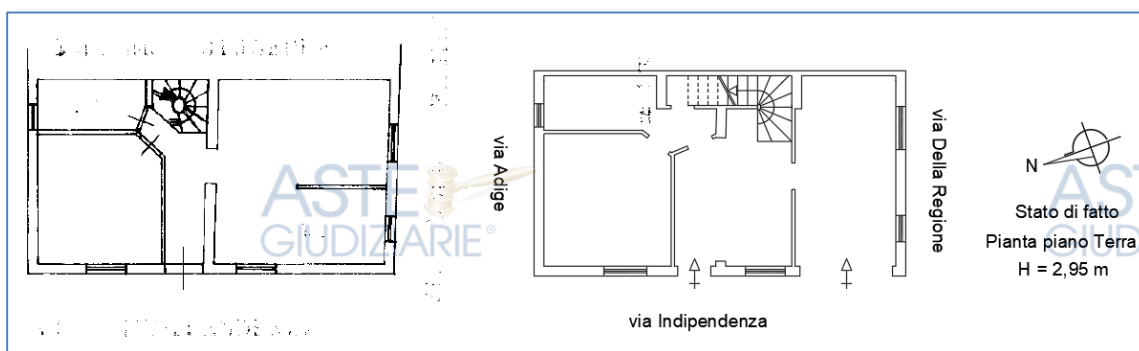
Confronto tra la Planimetria catastale a sx e la restituzione grafica dello stato dei luoghi a dx.
